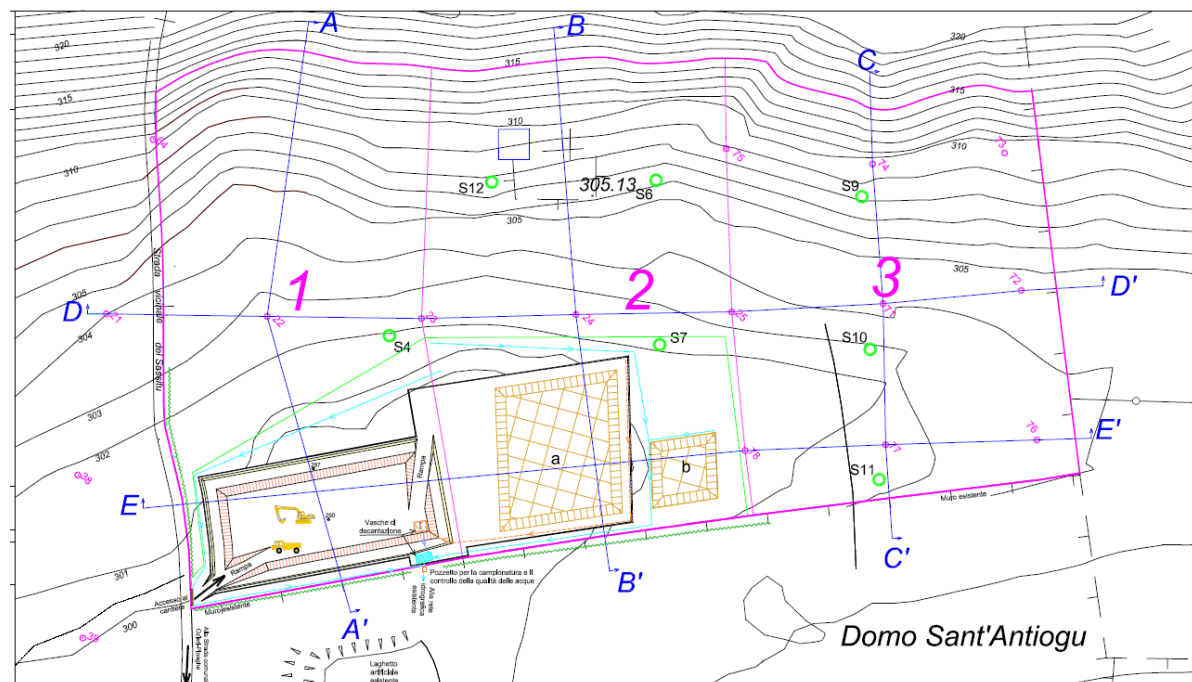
Stralcio elaborato planimetrico di progetto di coltivazione con indicazioni delle aree di pertinenza 3 lotti successivi (Tav. 5.3)
